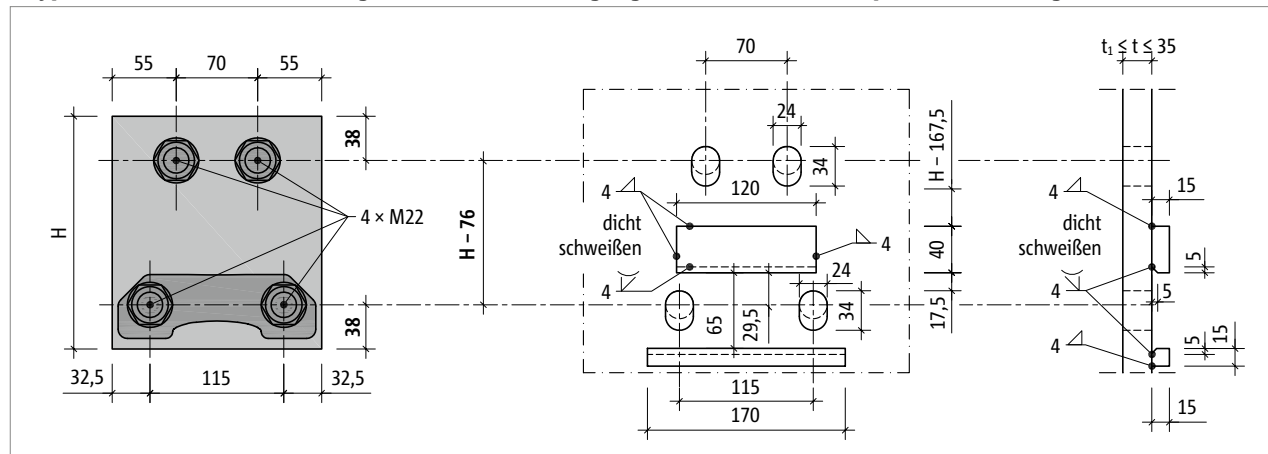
Schöck Isokorb® T Typ SKP-MM2...-CV28: Konstruktion des Stirnplattenanschlusses mit Betondeckung CV28; Rundlöcher unten, alternativ Langlöcher und eine zweite Knagge zur Übertragung der negativen Querkraft
